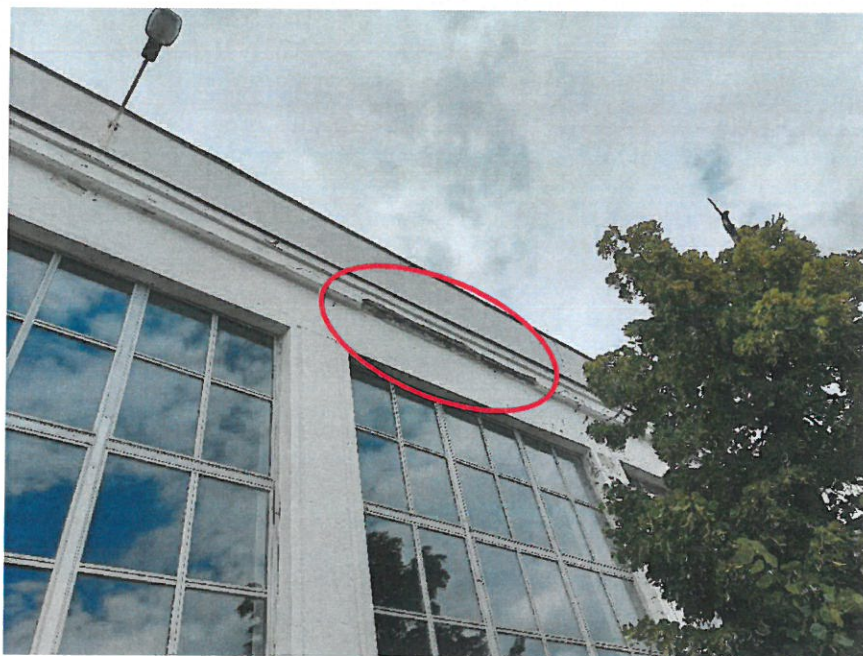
Widok ogólny stanu elewacji zewnętrznej
